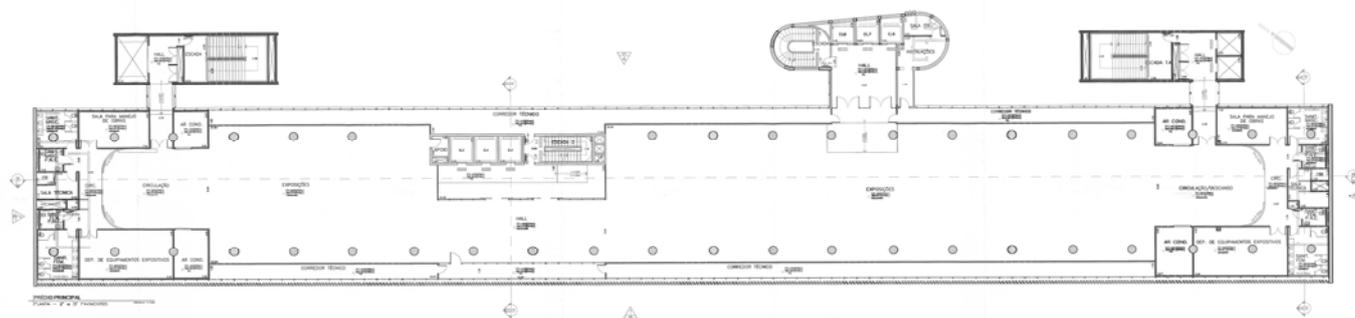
Antigo Palácio da Agricultura: planta do pavimento tipo conforme projeto de adaptação para o Museu de Arte Contemporânea.
